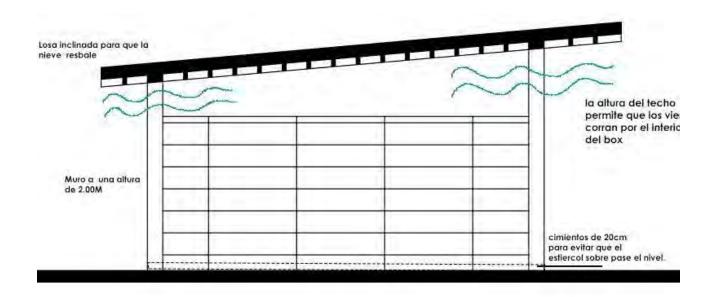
"Alzado del área de box, estrategias aplicadas". Fuente: Propia
